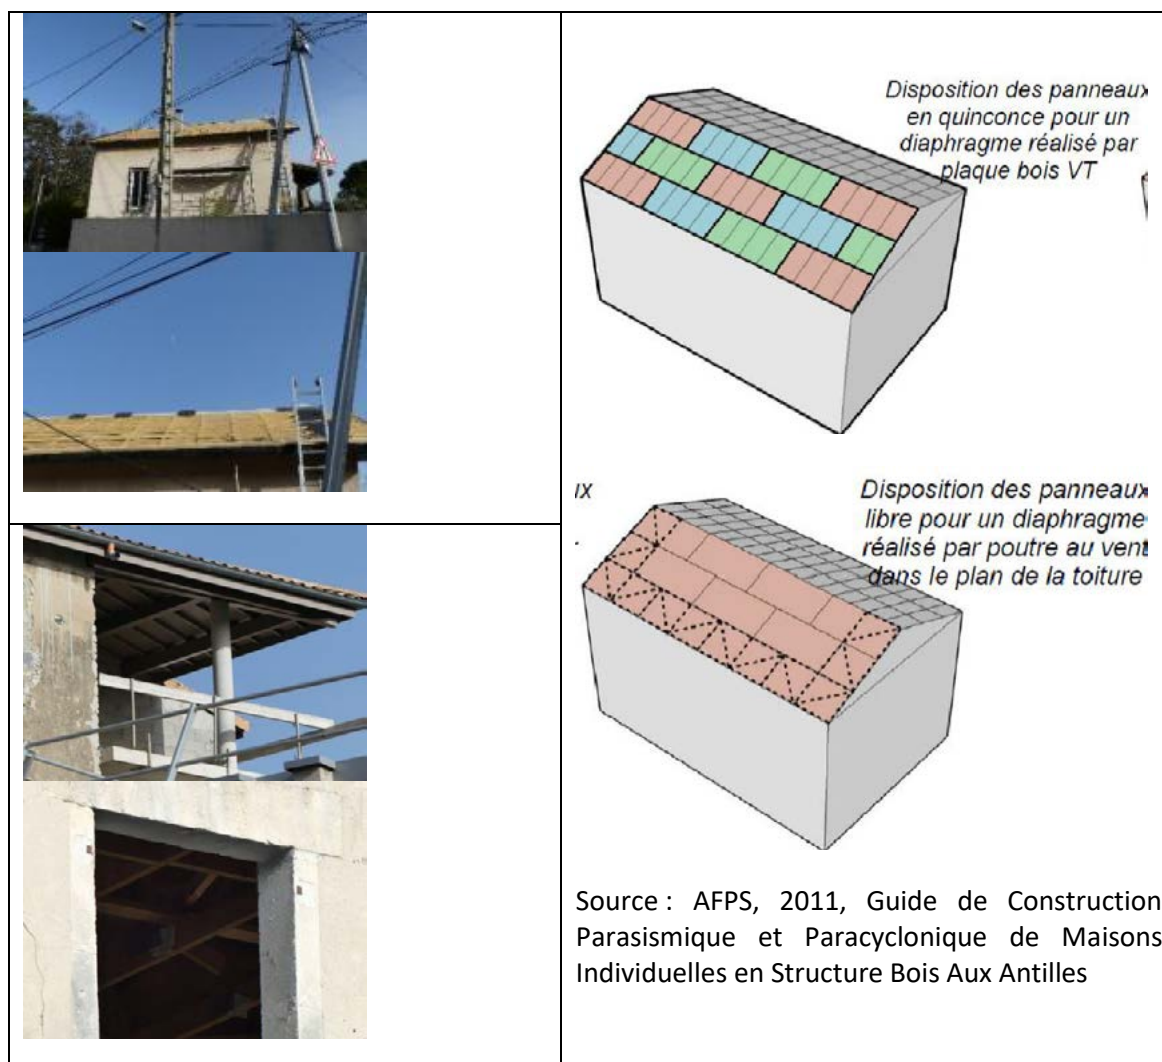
A gauche : exemples de travaux de reprise de la toiture avec mise en place de panneaux OSB en sous toiture et de liteaux avant la pose des tuiles ; à droite : préconisations issues du Guide DGPR.
